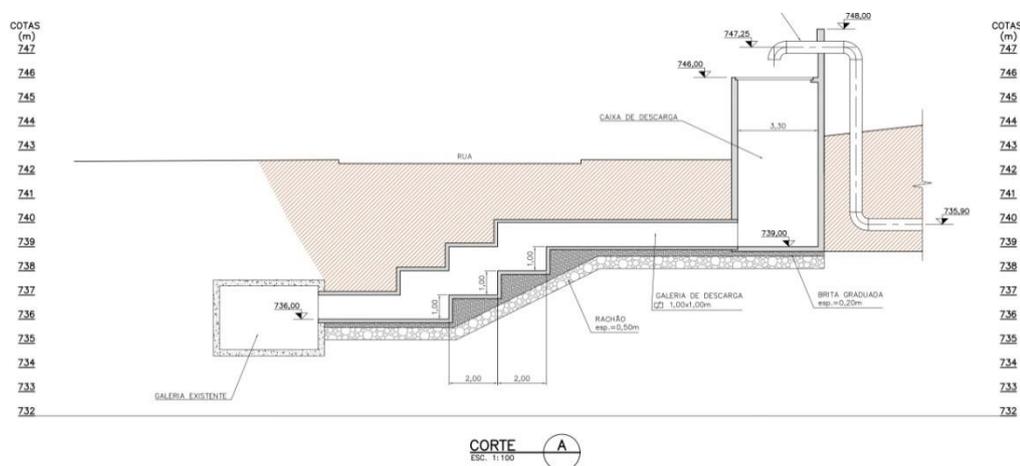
Perfil Longitudinal da Galeria de Descarga do Reservatório Moinho Velho
